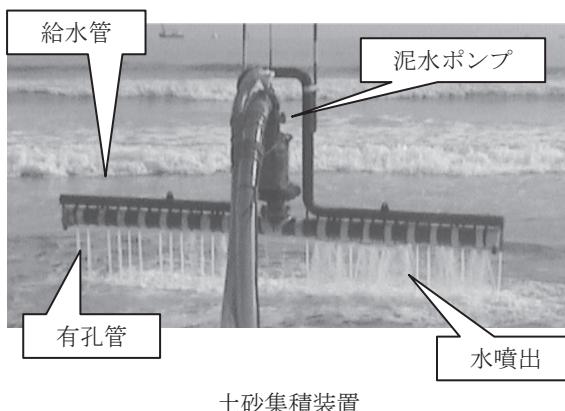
埋設有孔管による埋設土砂浚渫工事の状況
